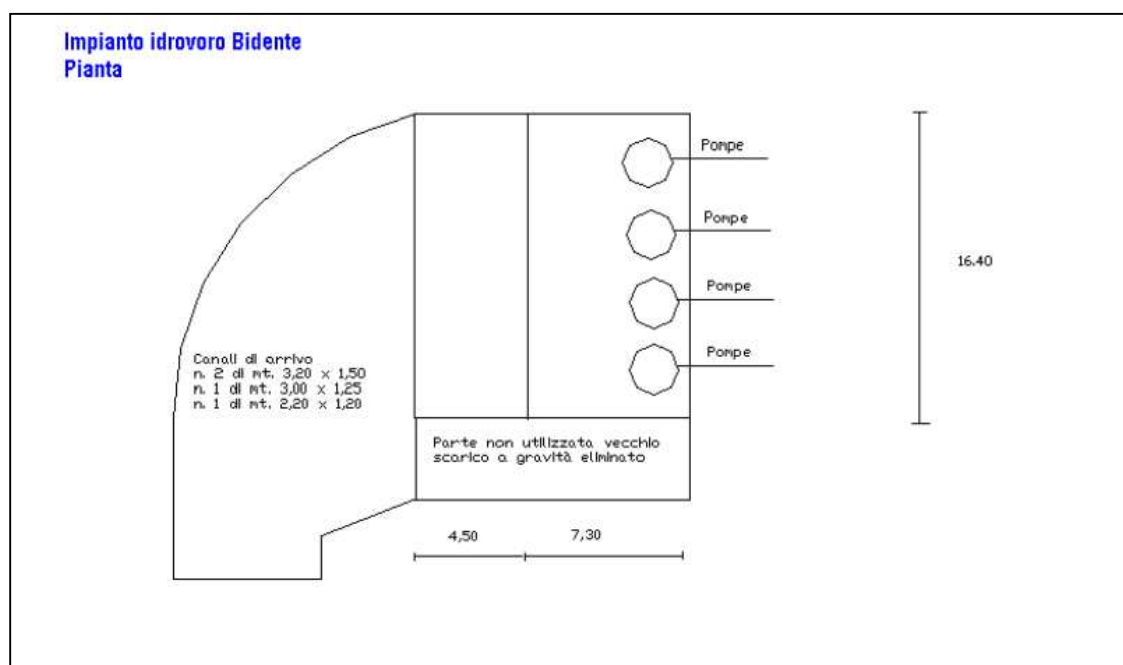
Pianta dell'Impianto Idrovoro Bidente
